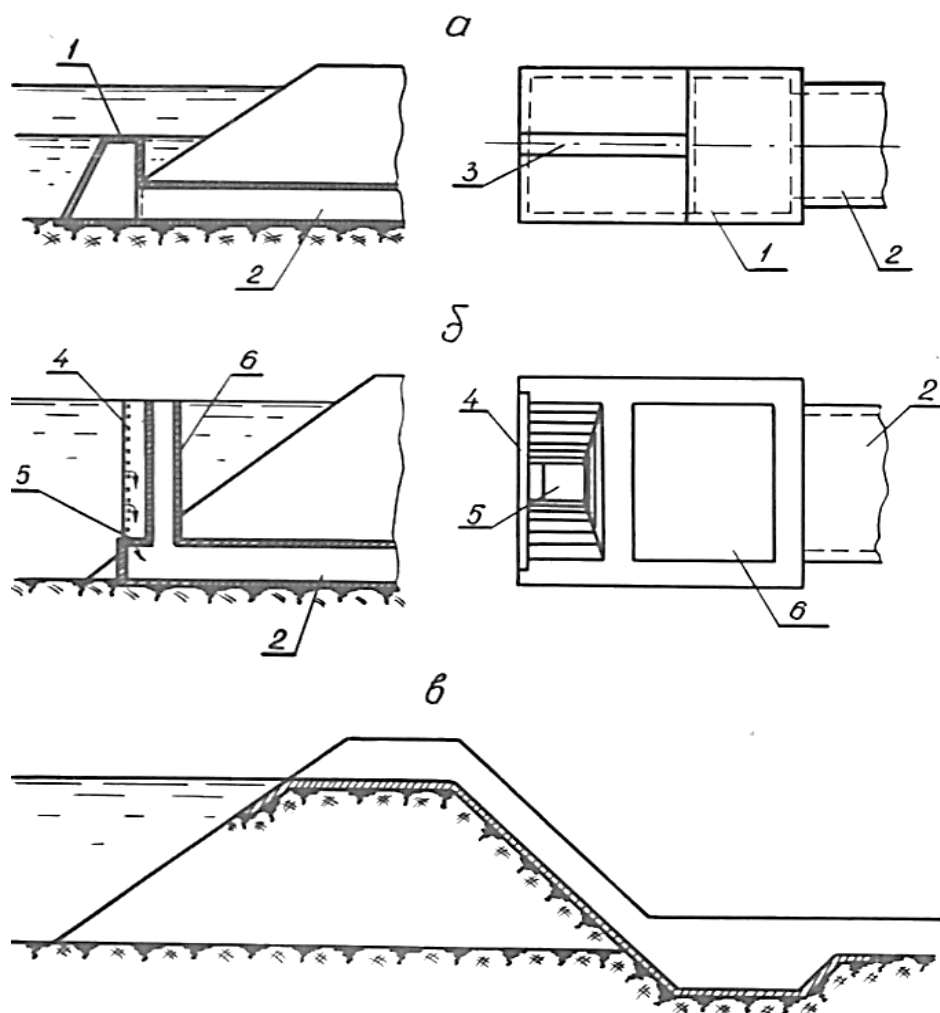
Водовыпуски, запроектированные проектным институтом «Киргизгипроводхоз». 1 - башня; 2 – водопроводящая труба; 3 – щель; 4 – решетки; 5 – водоприемные отверстия; 6 – катастрофический водосброс.
